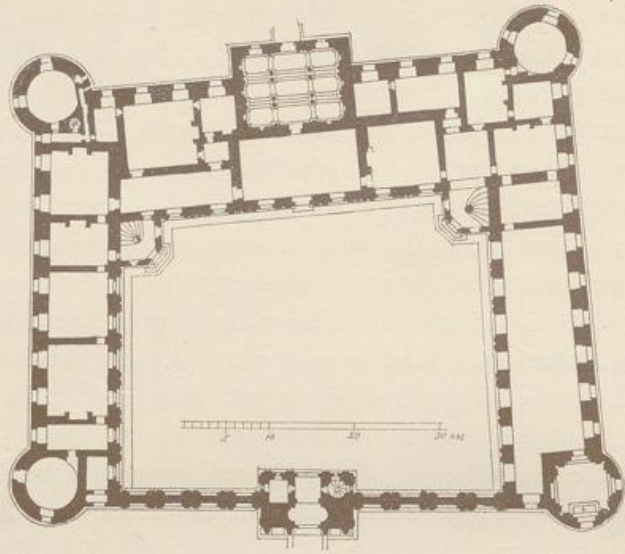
Château de Tanlay. Grundriss des Rez-de-chaussée.
